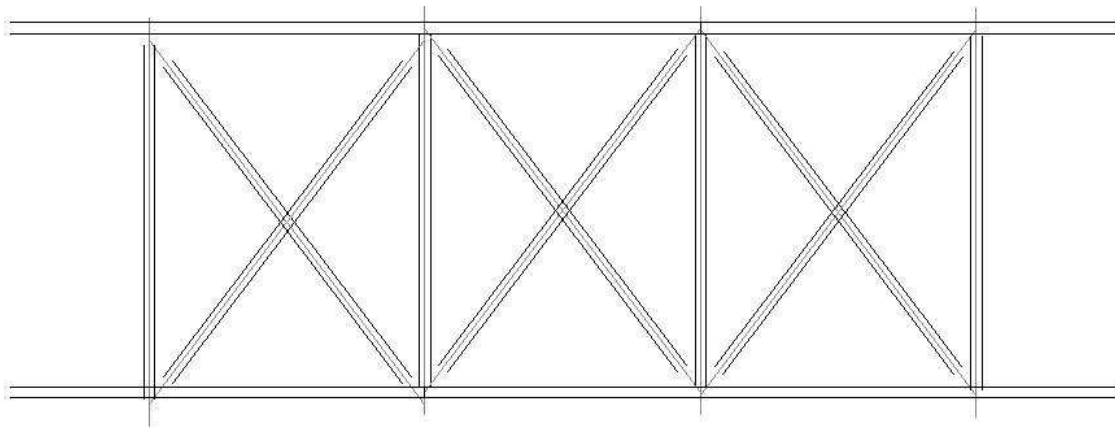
Estrutura de contraventamento horizontal superior (vista superior).
